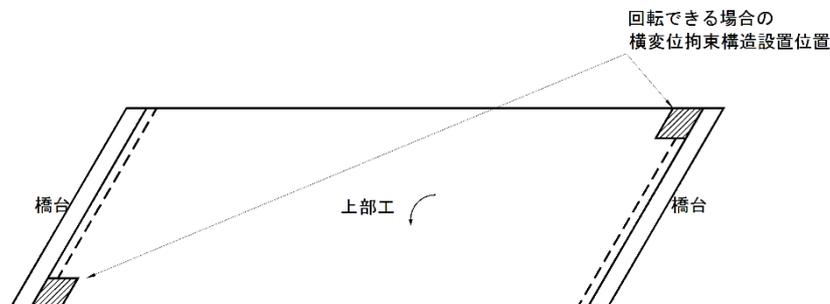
上部工構造が回転できる場合の横変位拘束構造設置位置
